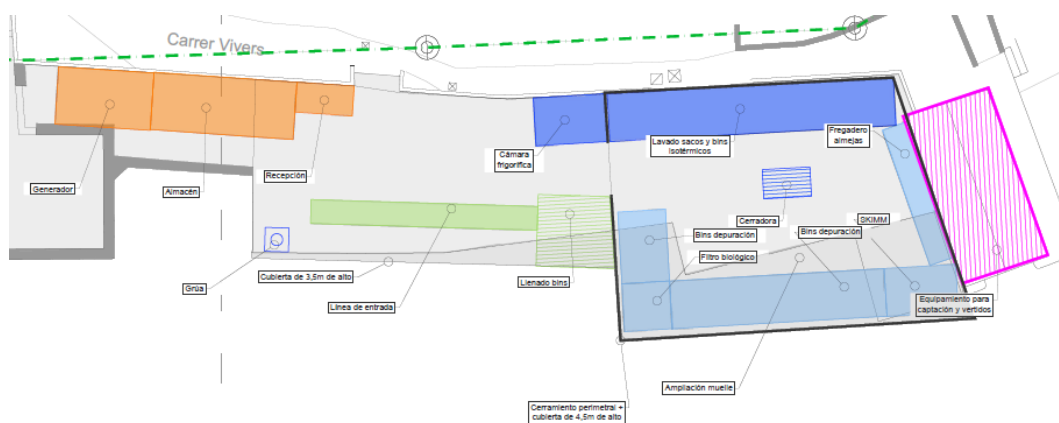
Planta propuesta para la alternativa 2 en las parcelas 8, 9 y 10.
